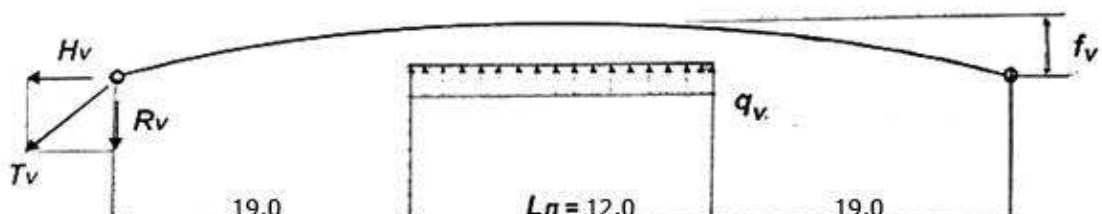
Расчетная схема к определению усилий от ветровой нагрузки
